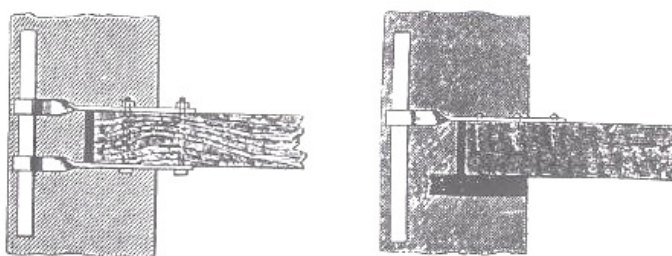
Reforço do apoio da viga na parede estrutural através de um ferrolho de aço (Lombardo et al.;1997).
